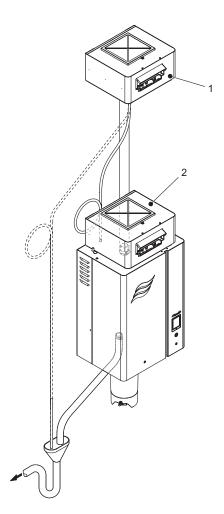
Configurations de montage de l'unité de ventilation Condair
